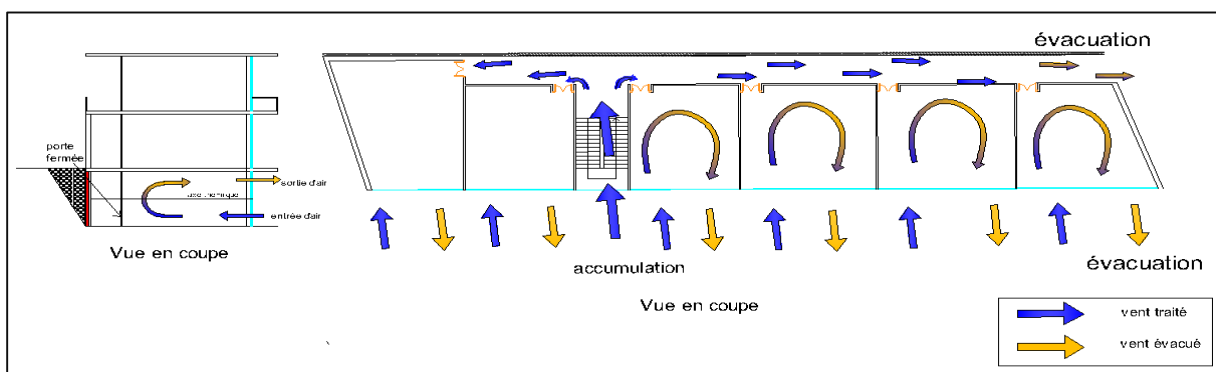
Ventilation monofaçade au niveau du sous-sol .Source : auteurs
